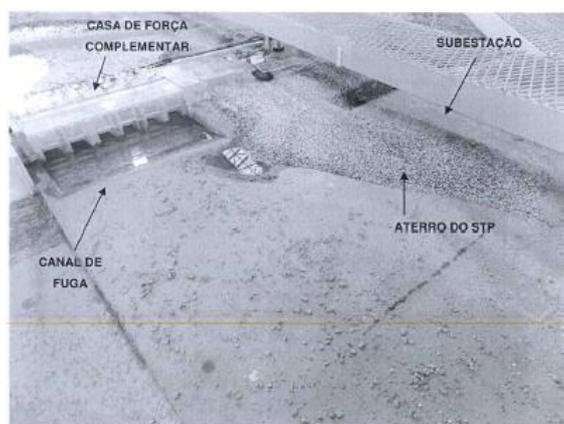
3b – Arranjo em planta da Alternativa Final para dique junto à entrada do STP (Figura 8, LACTEC CEHPAR (2012)).
